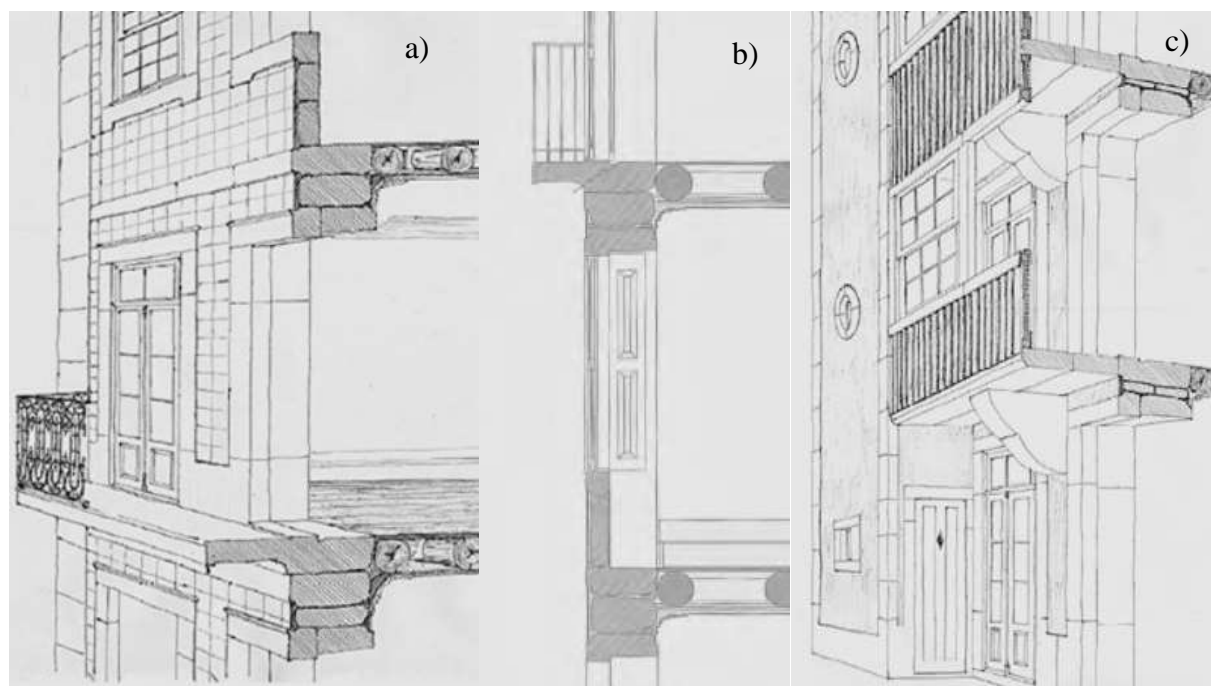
a) Corte de uma fachada principal; b) Corte transversal por uma fachada que abrange a janela de peito e de sacada; c) Corte tipo por uma fachada de tardo (Teixeira, 2009 e Basto, 2011).
